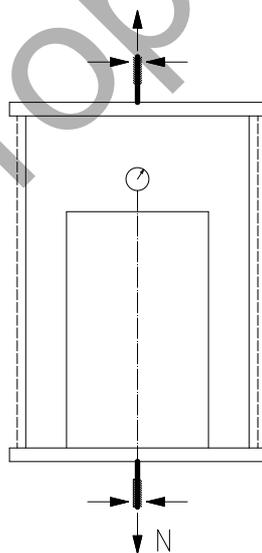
Схема установки для испытания на вытягивание арматурных стержней из бетонных цилиндров
